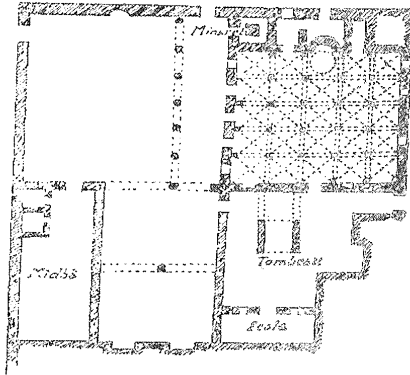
مسقط أفقي لجامع القصبة بتونس. عن:
